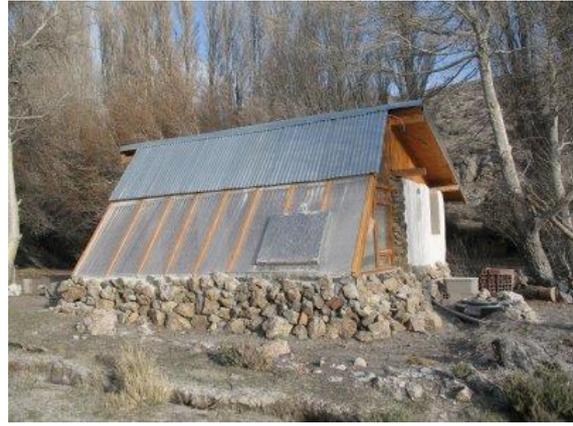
Vivienda construida con ‘champas’ y estructura de madera.
